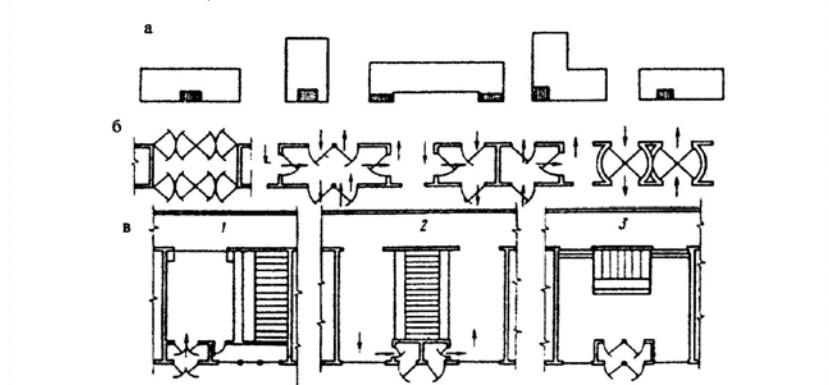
Планувальні схеми вхідних вузлів громадських будівель:
